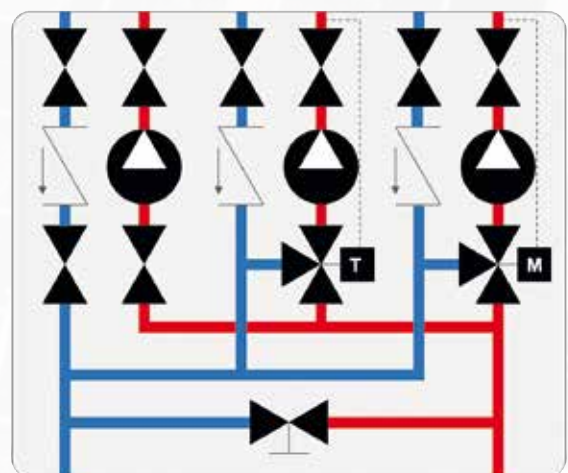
Hydraulikschema der kompletten Baugruppe
